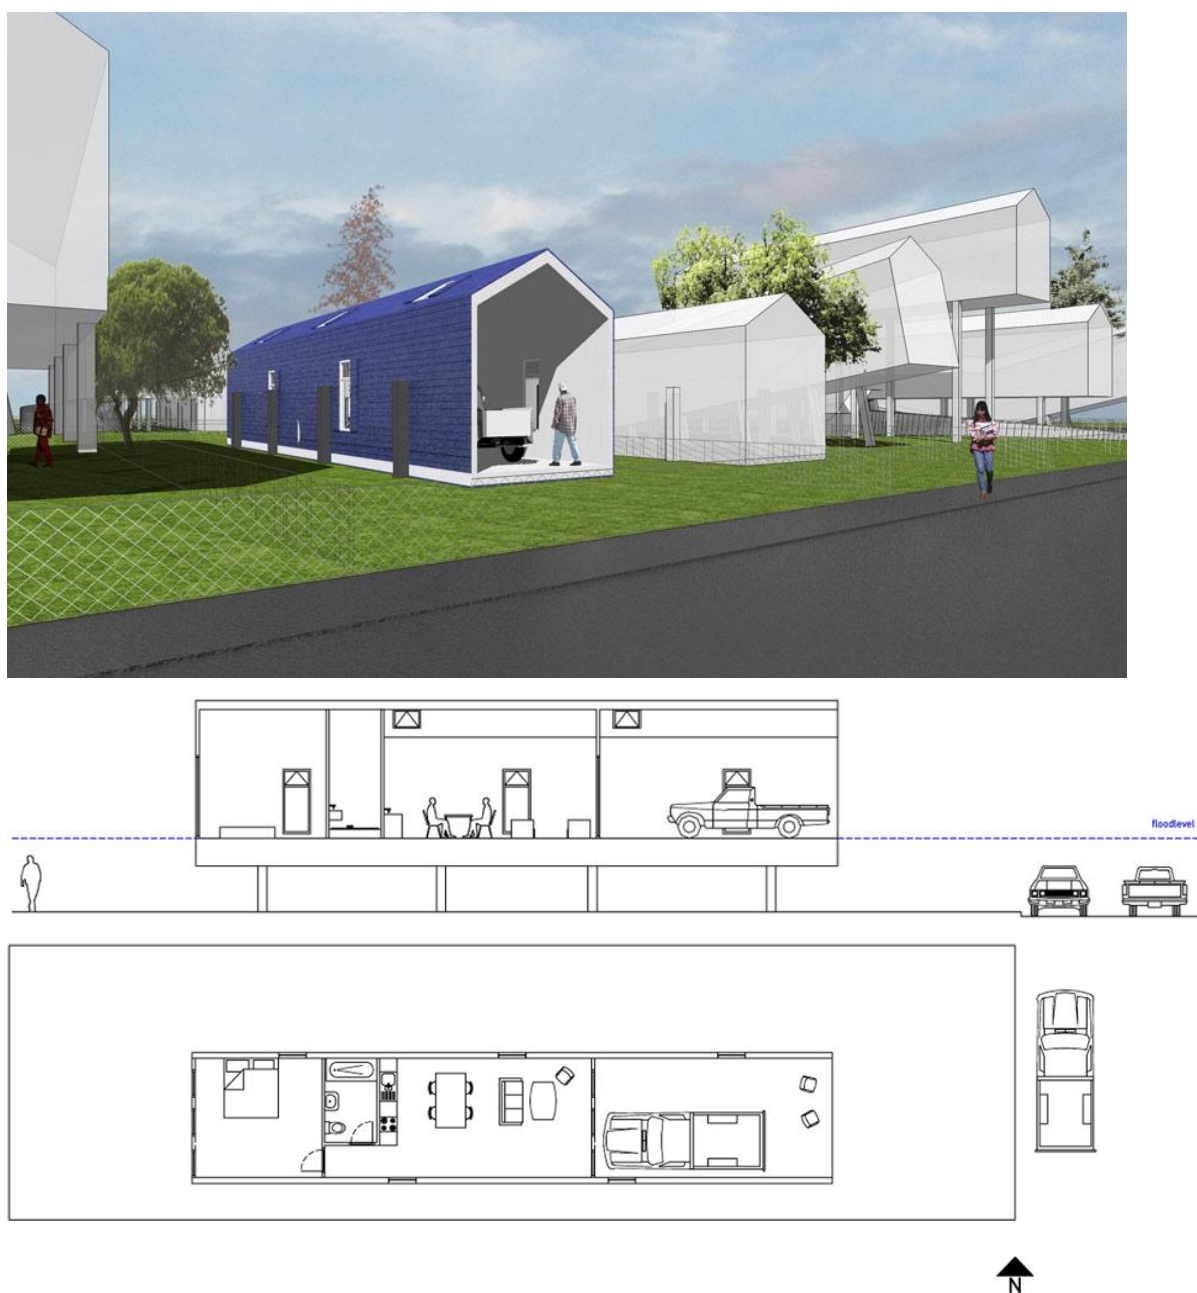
Perspectiva, corte e planta da casa flutuante.
